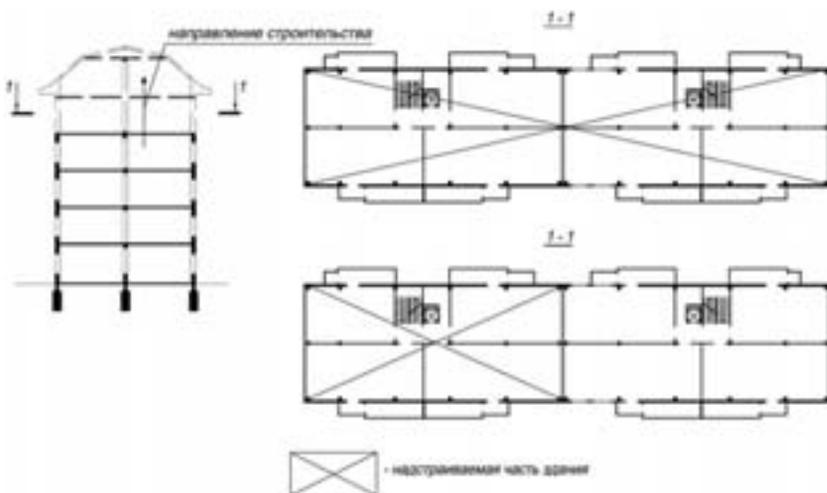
Принципиальная схема реконструкции здания путем надстройки этажей
